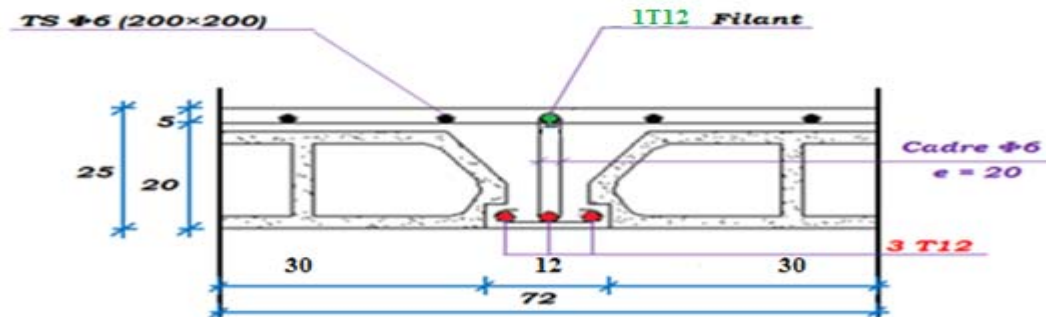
Coupe De Ferrailage Plancher Etage Courant 3 Travées
